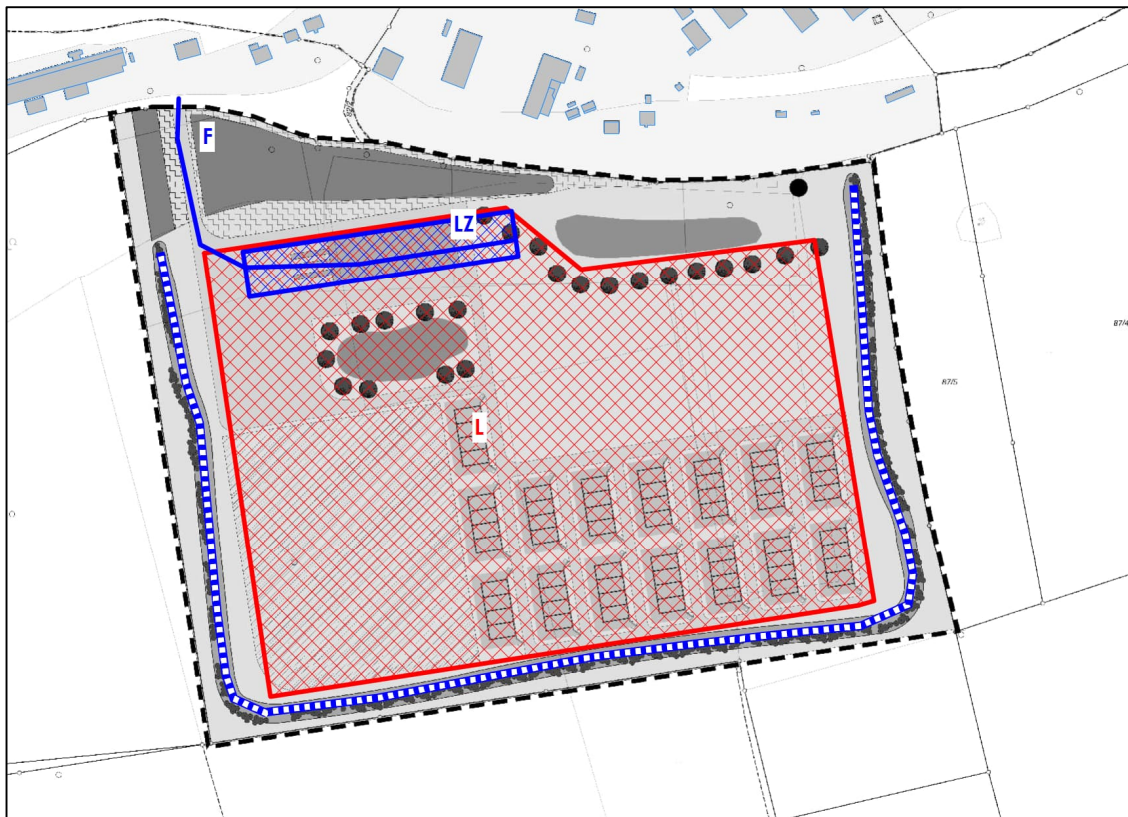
Lageplan mit Darstellung der relevanten Schallquellen
